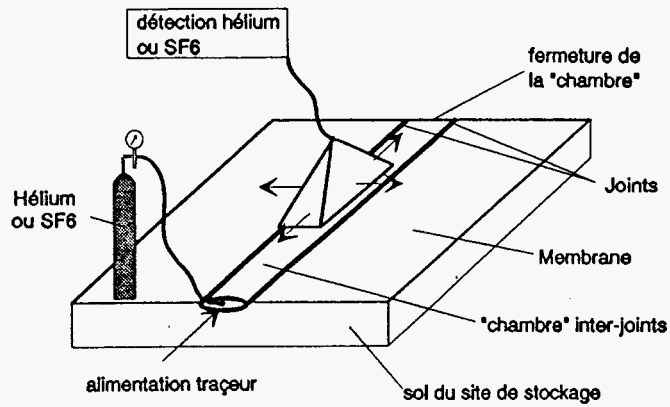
Vérification préalable de l'intégrité de la soudure.
